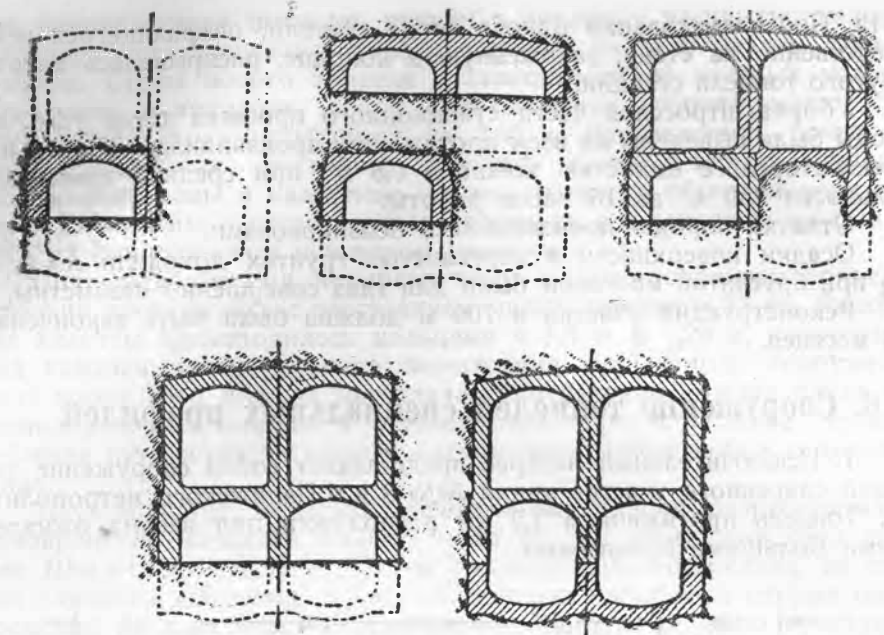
Фазы разработок двухэтажного тоннельного профиля.]
